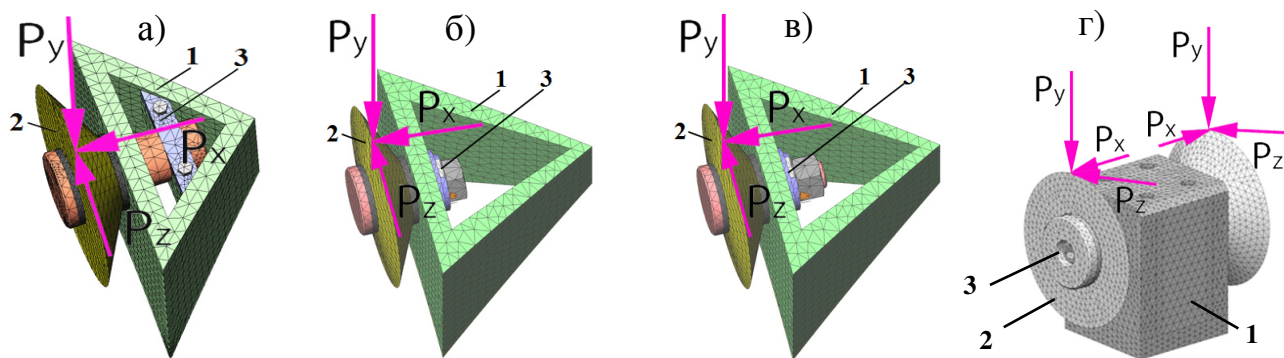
Конечно-элементные модели вариантов конструкций закрепления дискового инструмента к трехгранным (а, б, в) и четырехгранным (г) призмам: а) с планкой-замком; б) с крепежным винтом; в) с гайкой; 1 – призма; 2 – дисковый инструмент; 3 – узел крепления
